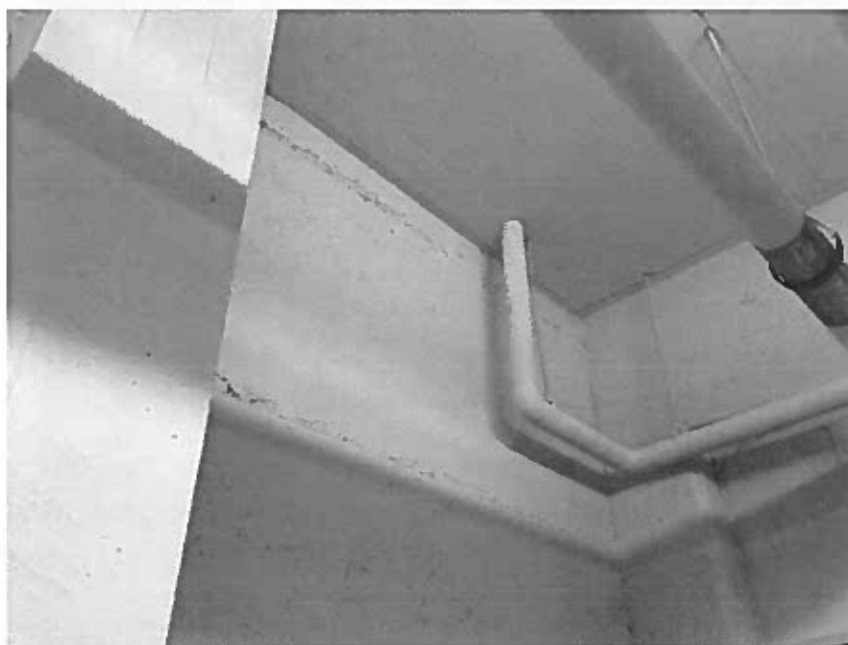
Sous-sol, salle d'archivage – Mur et plafond recouverts d'une peinture blanche (échantillon P-1)
